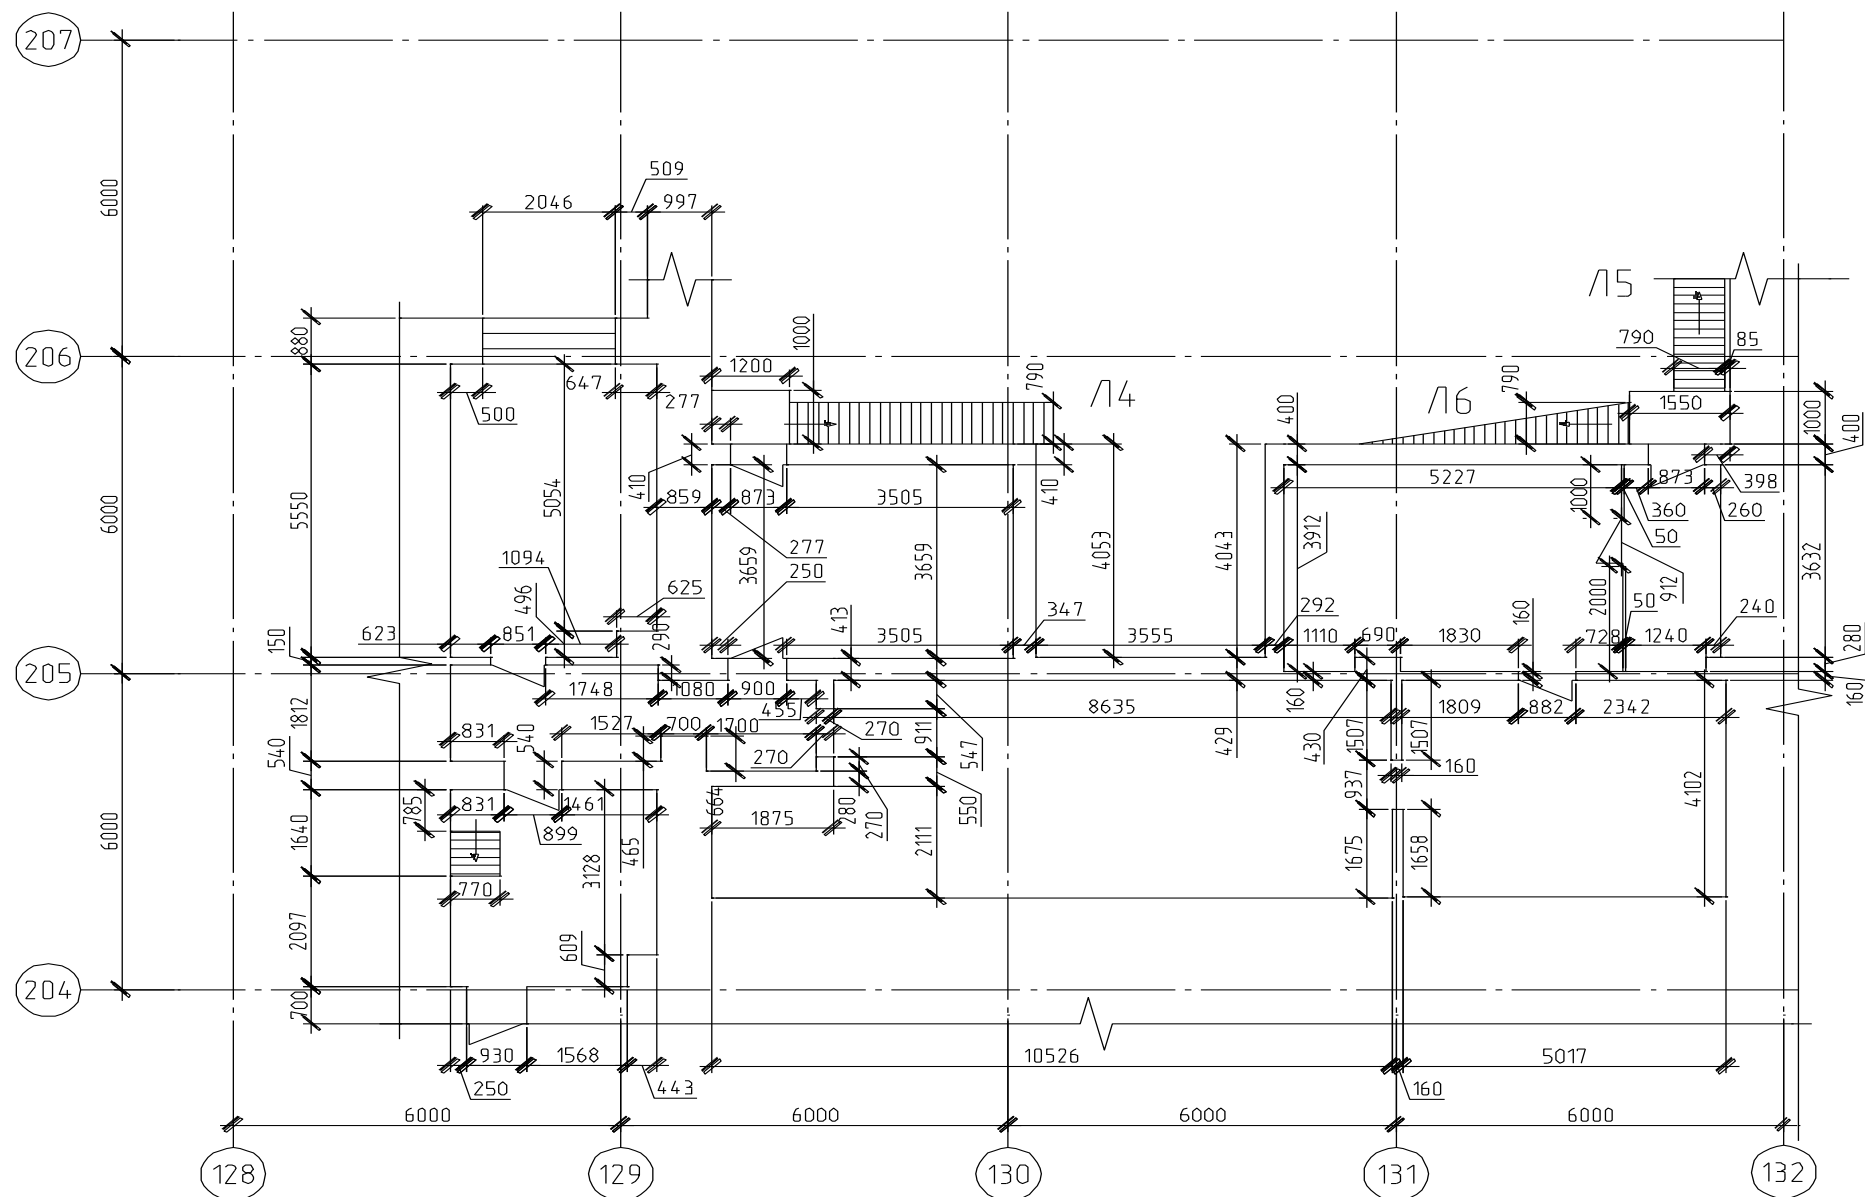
План 2-го этажа в осях «204-207/128-132» на отм.4.200
